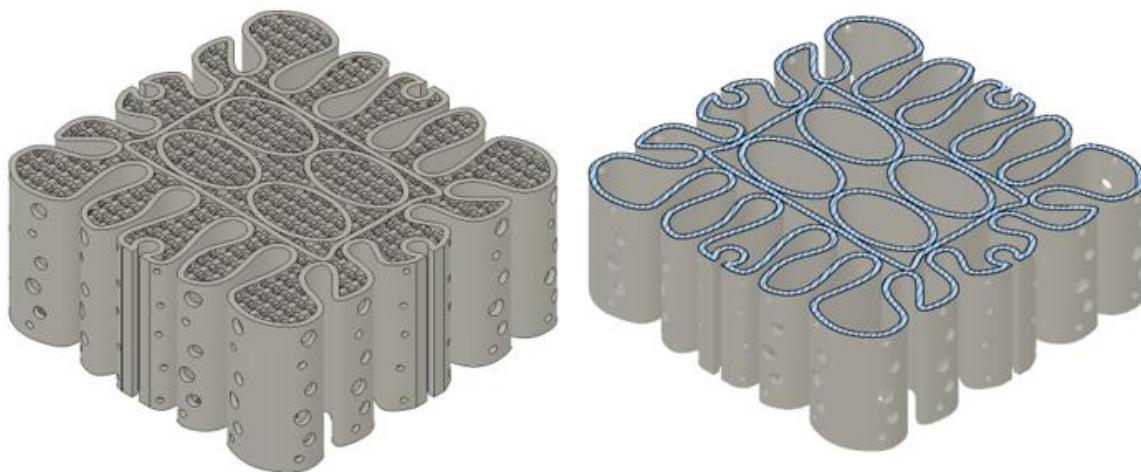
Prikaz izgleda betonskih elemenata - ploča
